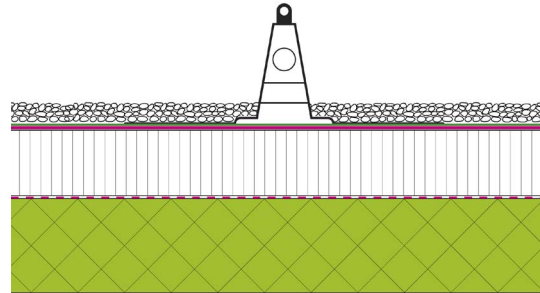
Ausstattungskategorie 1; EAP auf einem wärmegeämmten Flachdach eingebaut, Variante auf der Abdichtung mit Substrat beschwert. (Herstellerangaben beachten, Wintertauglichkeit abklären)
